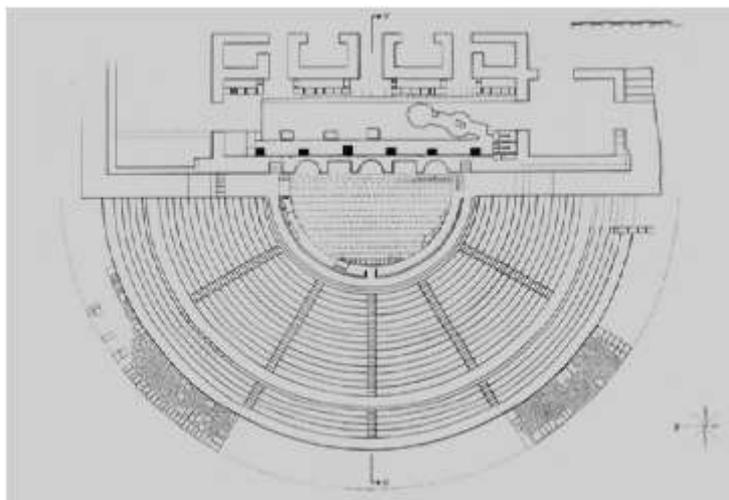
Planta do Anfiteatro Romano de Acinipo, Espanha
